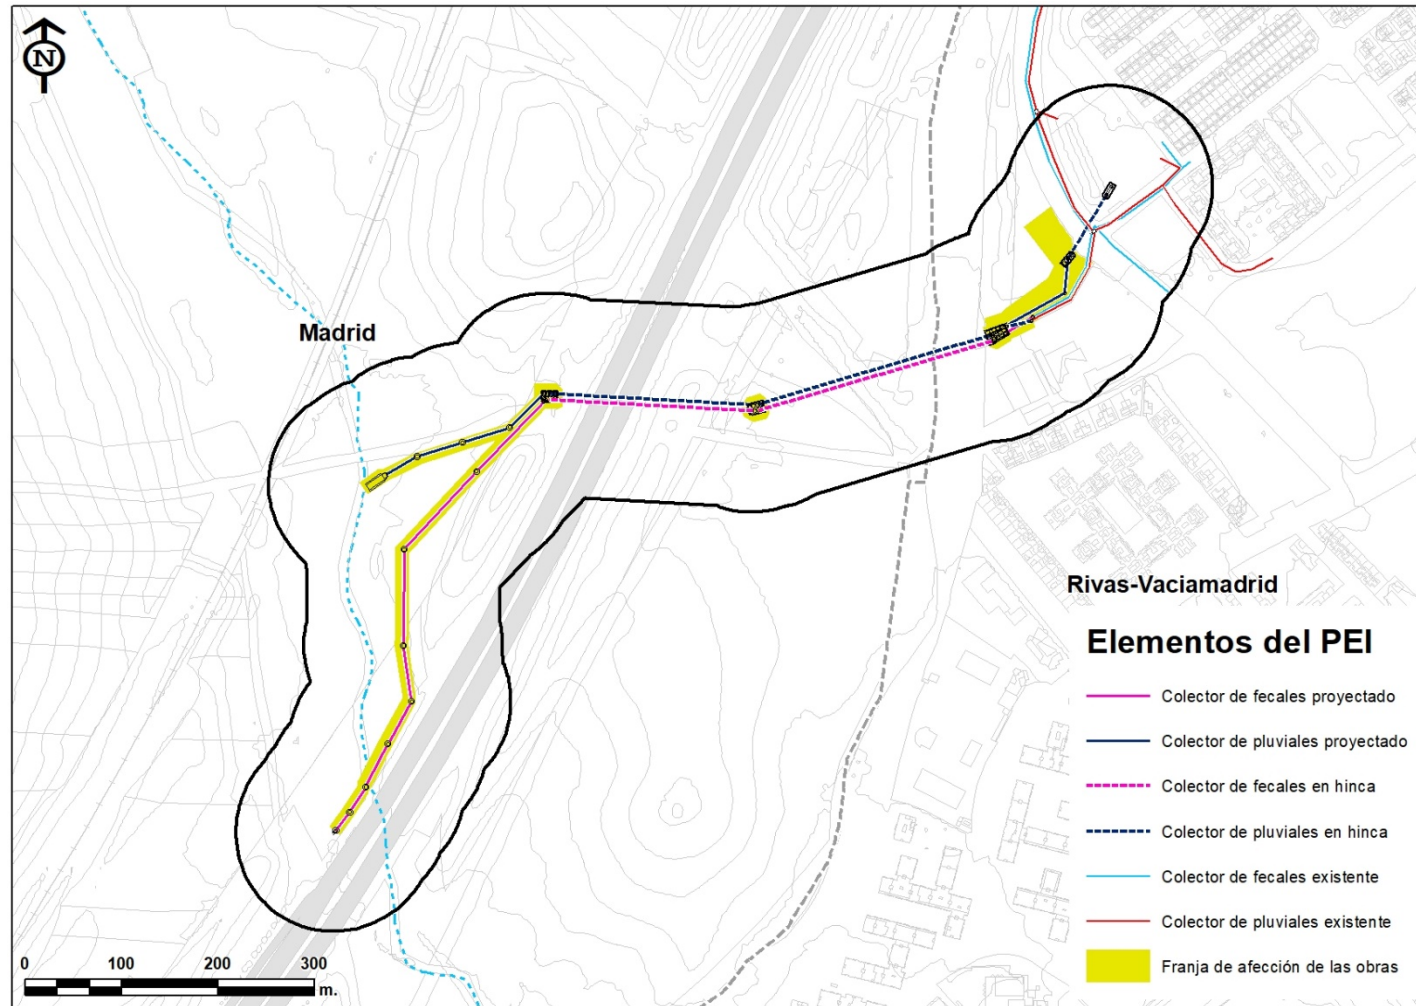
Ámbito Espacial del Plan Especial de Infraestructuras. Fuente. Elaboración propia.
